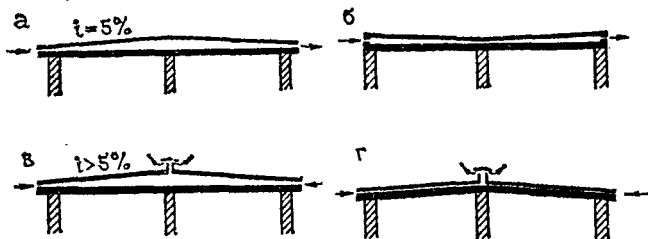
Схемы вентилируемых бесчердачных покрытий
